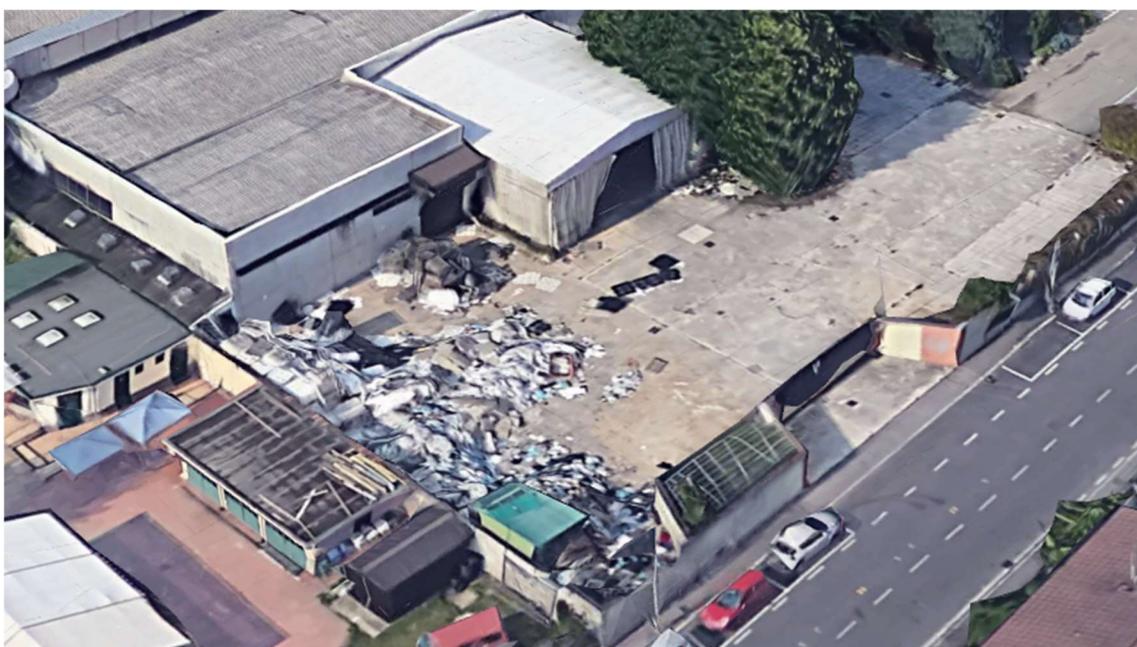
Stato di degrado dello stabilimento, lato Via del Santuario
